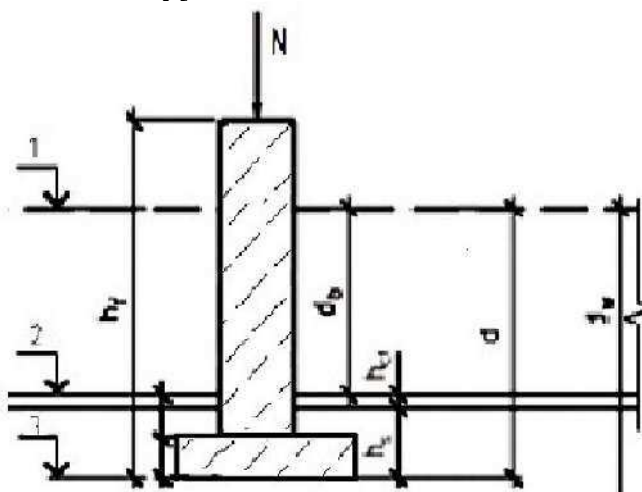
Расчетная схема ленточного фундамента.
